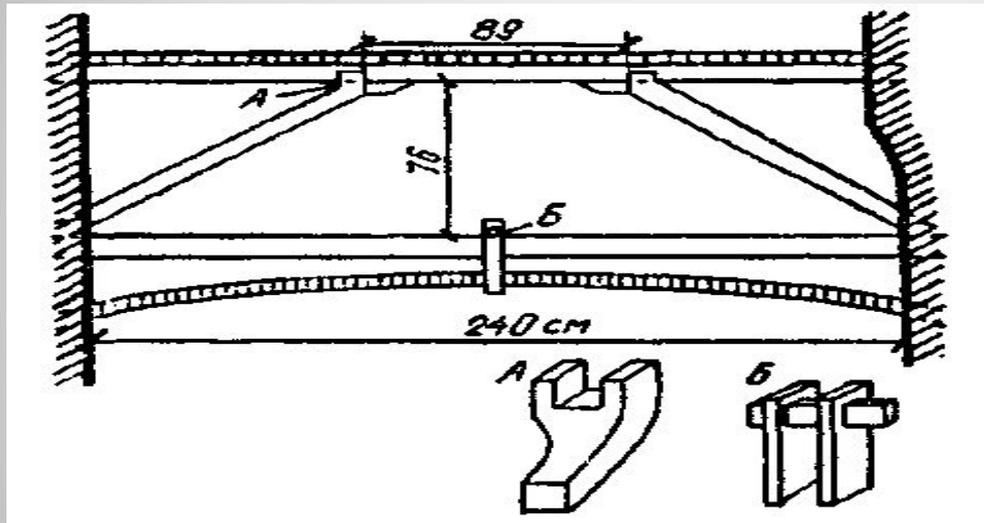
Перекрытие коридора в Покровском соборе (Москва, 1560 г.)
